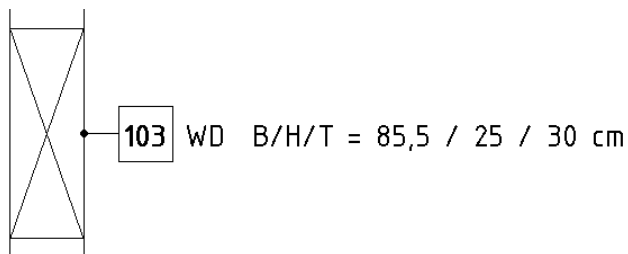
Darstellung eines Wanddurchbruchs inkl. Beschriftung
